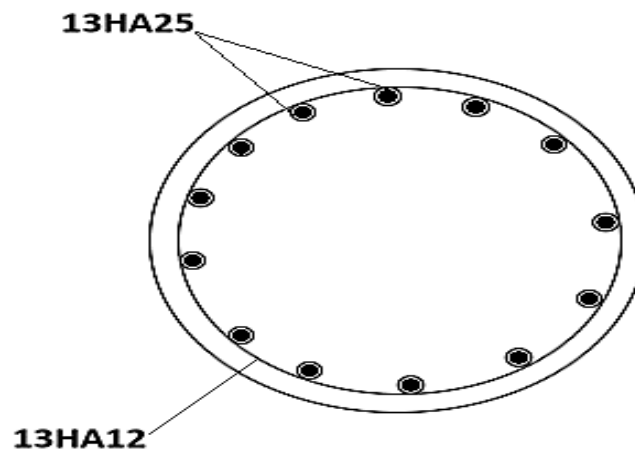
COUPE TRANSVERSAL DU FERRAILLAGE DE FUTS
